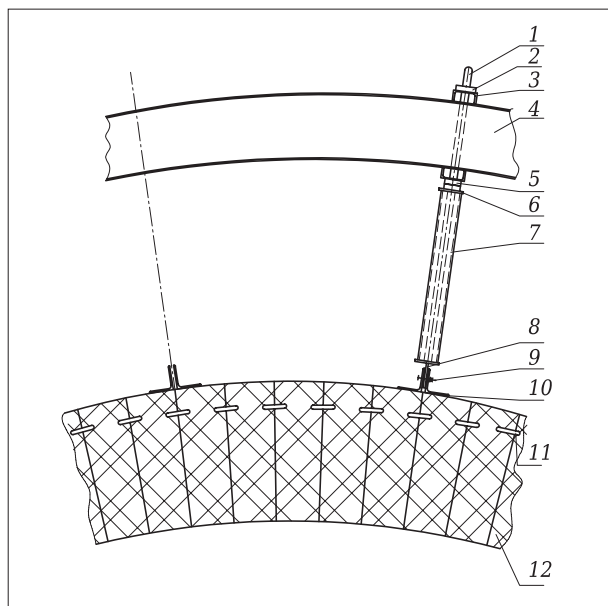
Продольный разрез крепления свода подвесками: 1 — тяга; 2 — клин; 3 — швеллер; 4 — несущие дуги; 5 — прокладка; 6 — шайба; 7 — трубка; 8 — подвесная пластина; 9 — болт; 10 — уголки; 11 — штырь; 12 — кирпич
